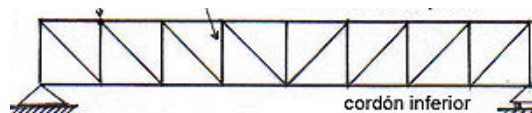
Cercha PRATT. Fuente: http://www.construmatica.com/construpedia/Viga_Pratt (2017).
